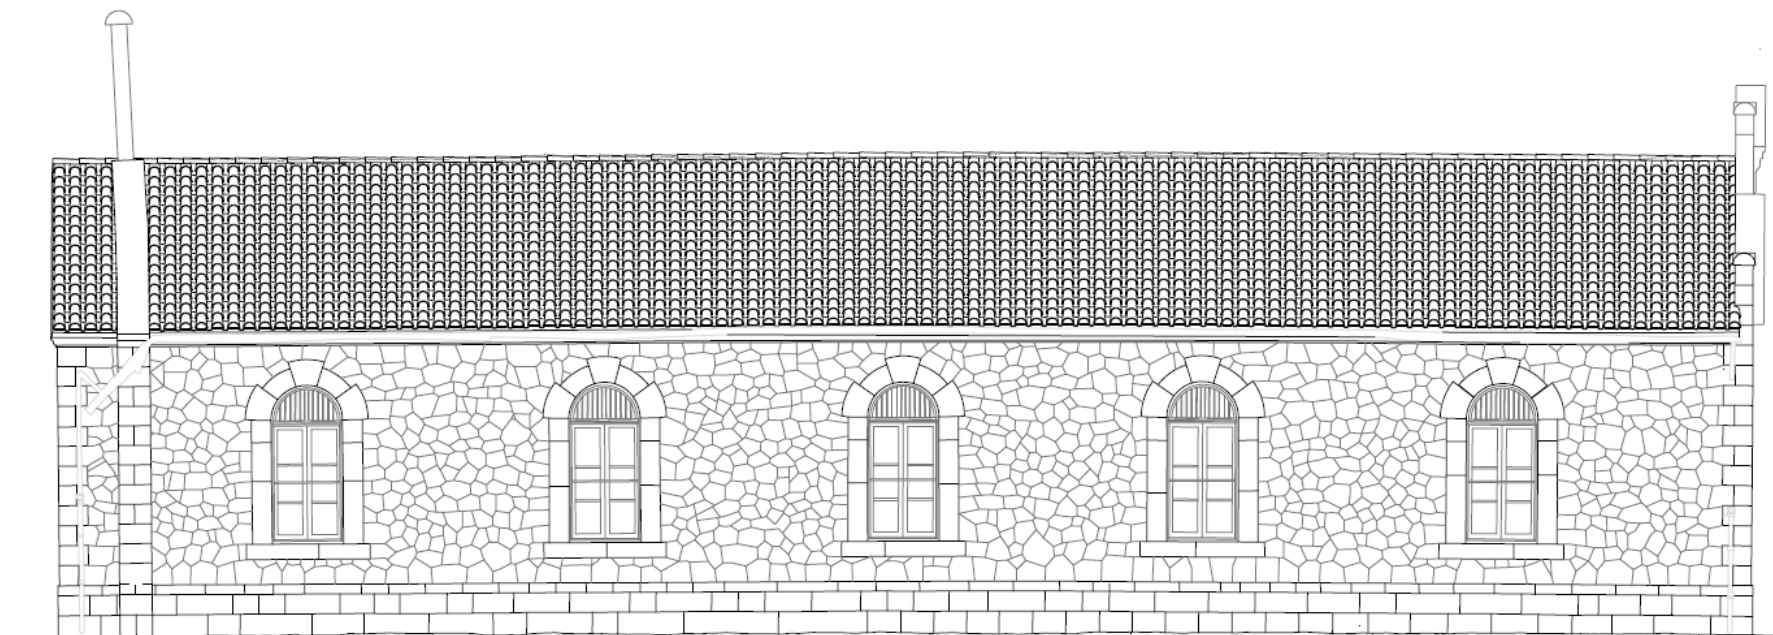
Alzado lateral Oeste. Levantamiento planimétrico.
